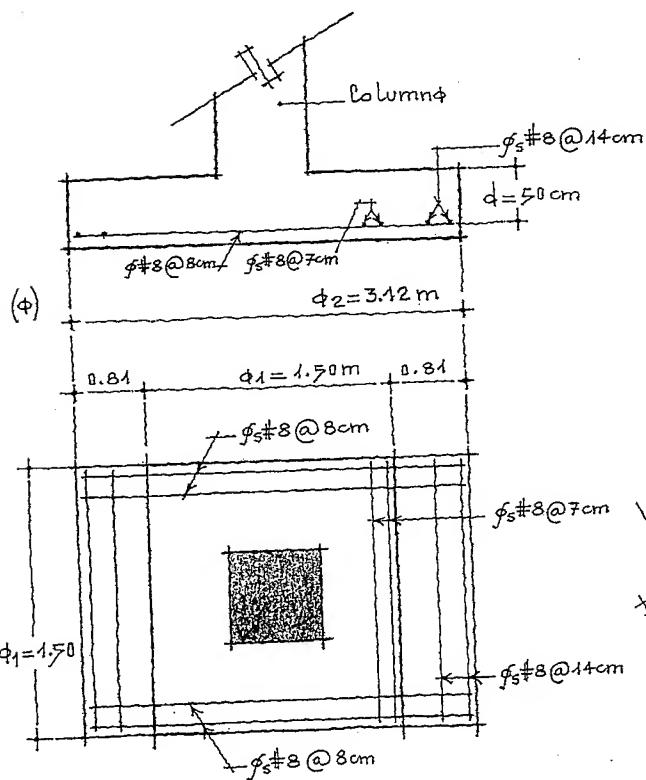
Planta de la zapata mostrando armados, (b).
